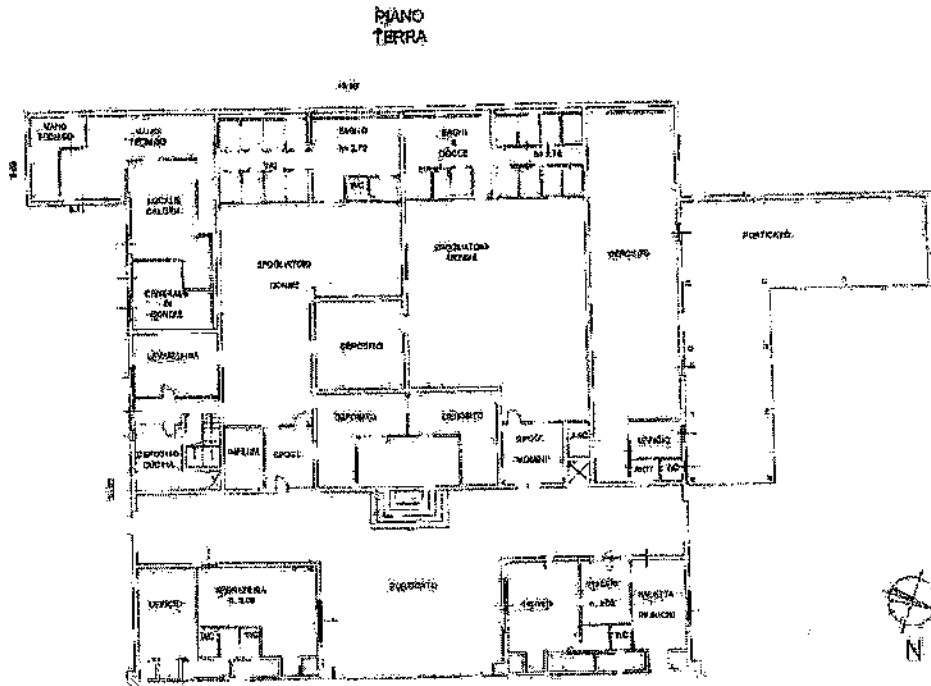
Stralcio della planimetria catastale del piano terra dell'immobile in esame
